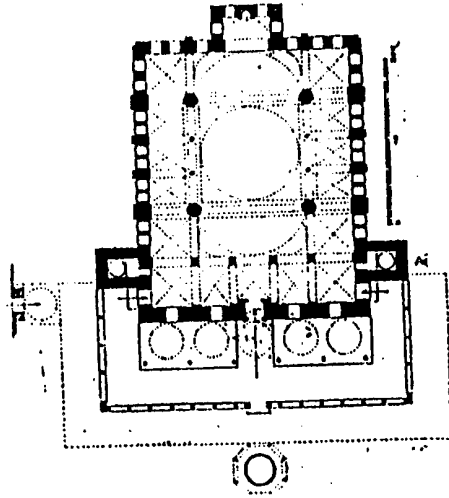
مسقط أفقي لجامع شرف الدين بقونية
